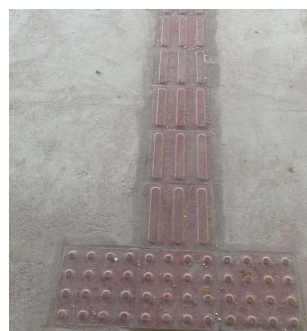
PISO PODOTÁTIL, DIRECIONAL OU ALERTA, ASSENTADO SOBRE ARGAMASSA, VERMELHA.
